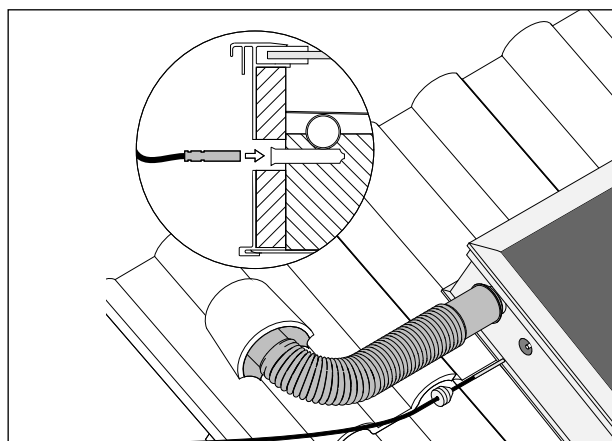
Fühlermontage: Fühler durch den Gummistopfen führen und Fühlerspitze in Fühlerhülse stecken. Gummistopfen wieder eindrehen.
